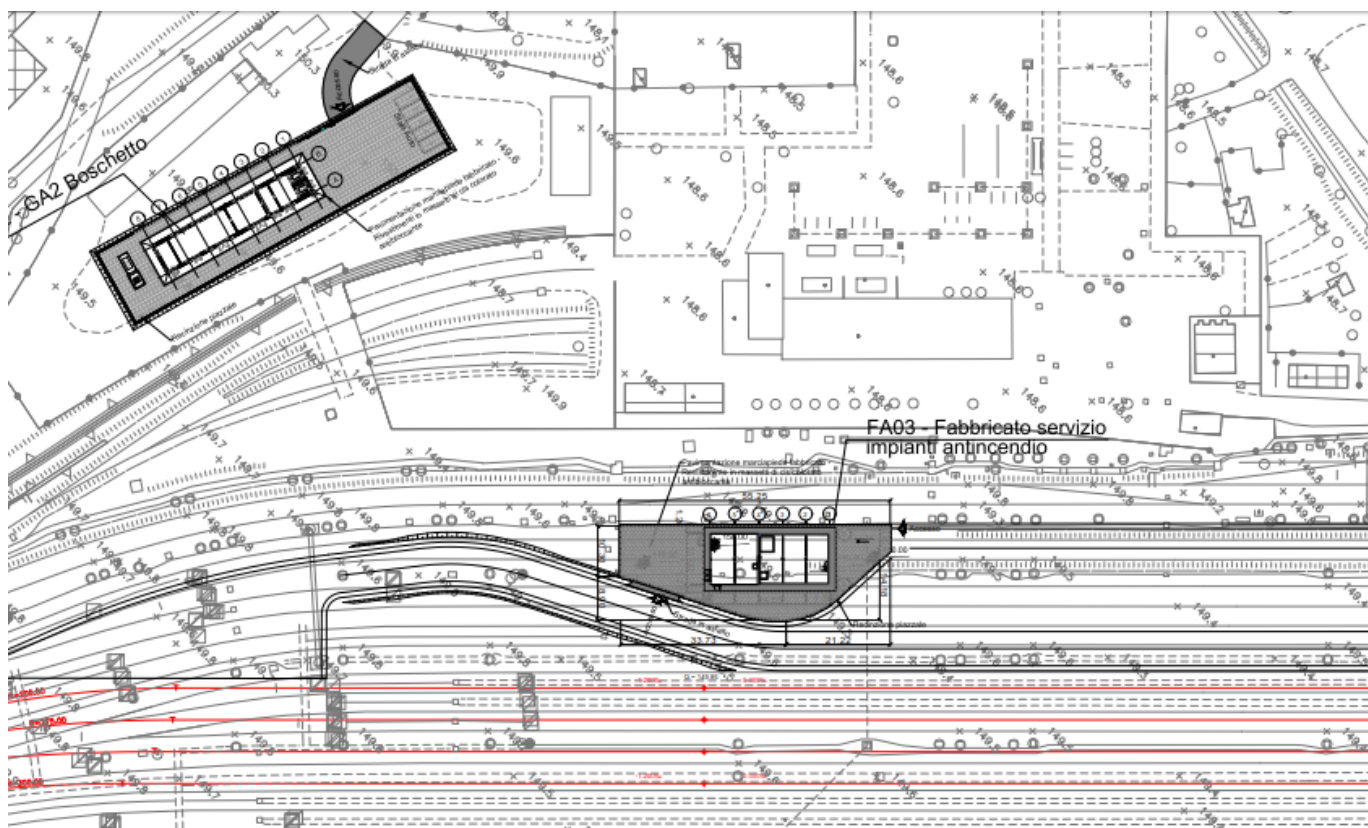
COLLOCAZIONE PLANIMETRICA FABBRICATO FA03
